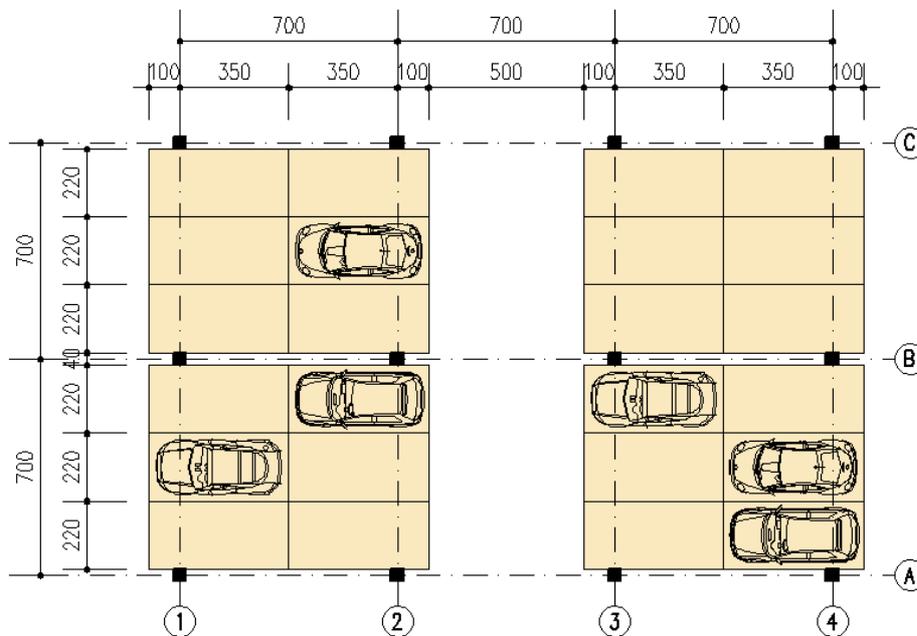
Modulação dos pilares do projeto de garagem para a Praça Rui Barbosa
